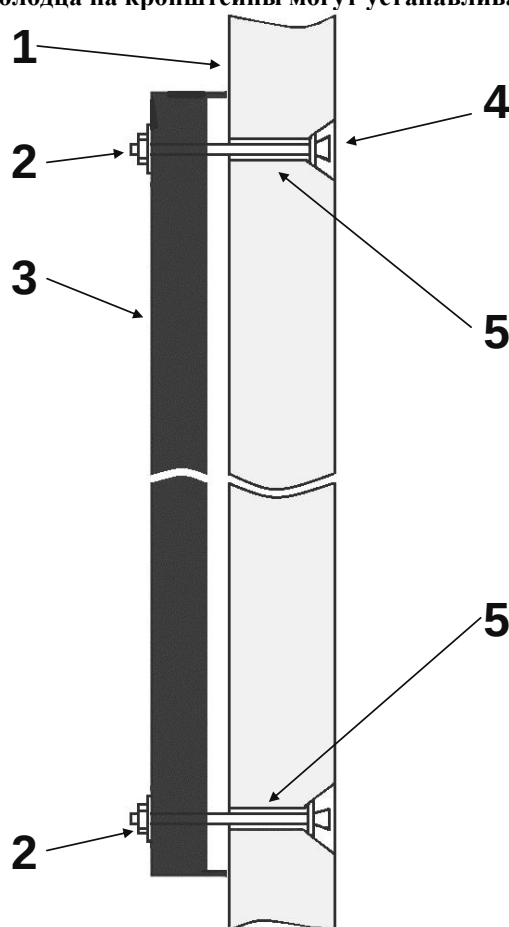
Крепление кронштейнов ККП на стене колодца «ККСр-2,5-10(80)»:
